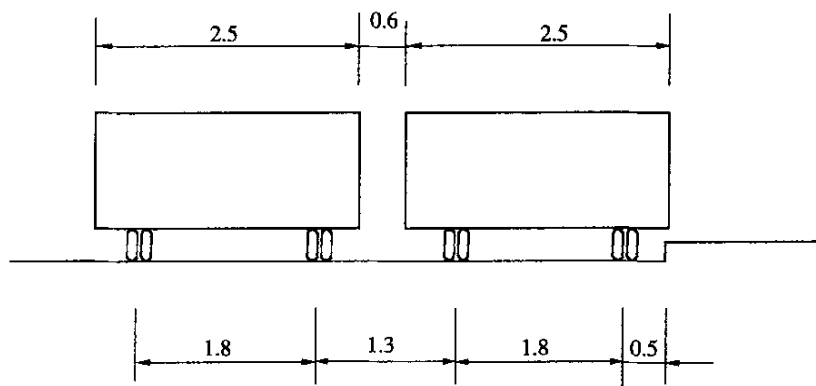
车辆荷载横向布置(图中尺寸单位为 m)
